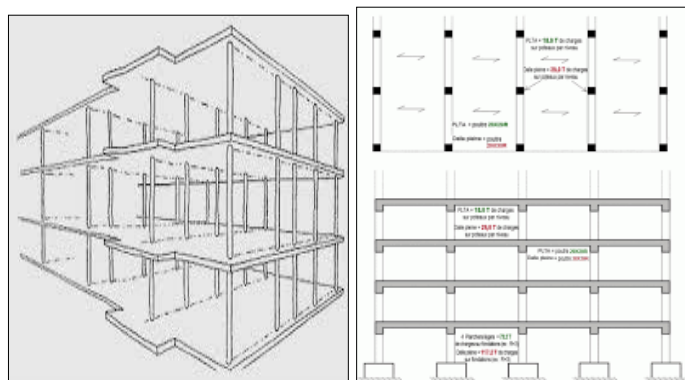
plan +coupe d'un system de structure pourtique SOURCE : <http://docs.autodesk.com>
